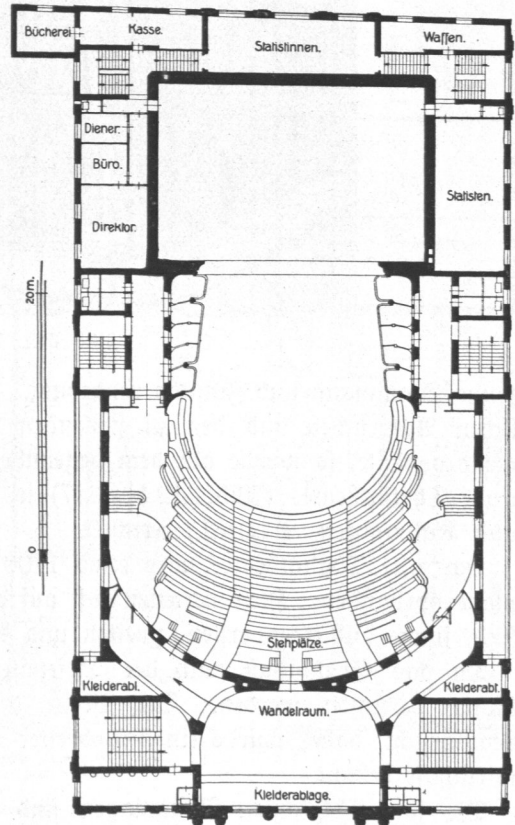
Deutsches Schauspielhaus, Obergeschoß, Grundriß.
